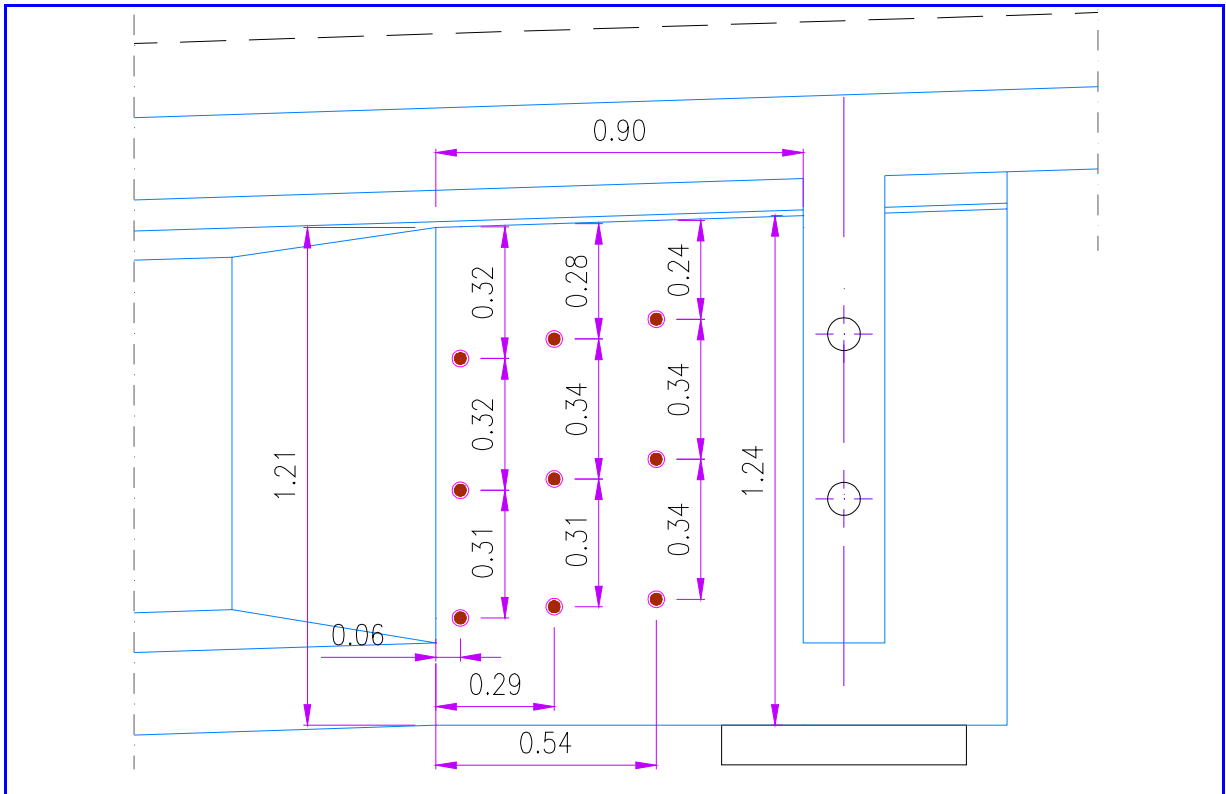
Schema tipo delle rilevazioni effettuate sulla testa (Testa sud, trave H, campata 1)
